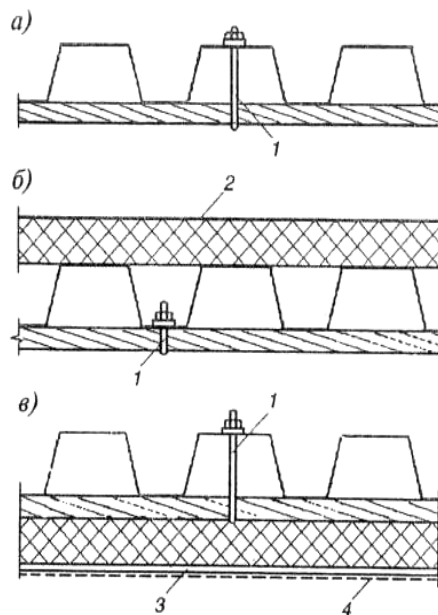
Конструкция кровли из профилированных листов: а – без утеплителя; б – с верхним расположением утеплителя; в – с размещением утеплителя под настилом; 1 – болт с крючком; 2 – гидроизоляционный ковёр; 3 – пароизоляция; 4 – поддерживающая сетка
